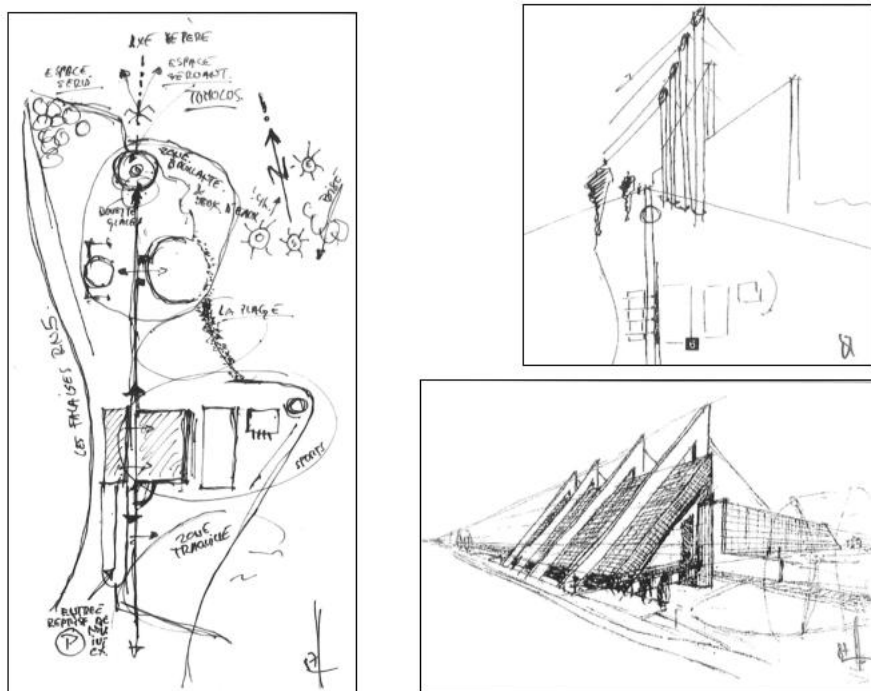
Esquisses et schémas de l'architecte M. Pierre Studer. Sources : M. Pierre Studer
